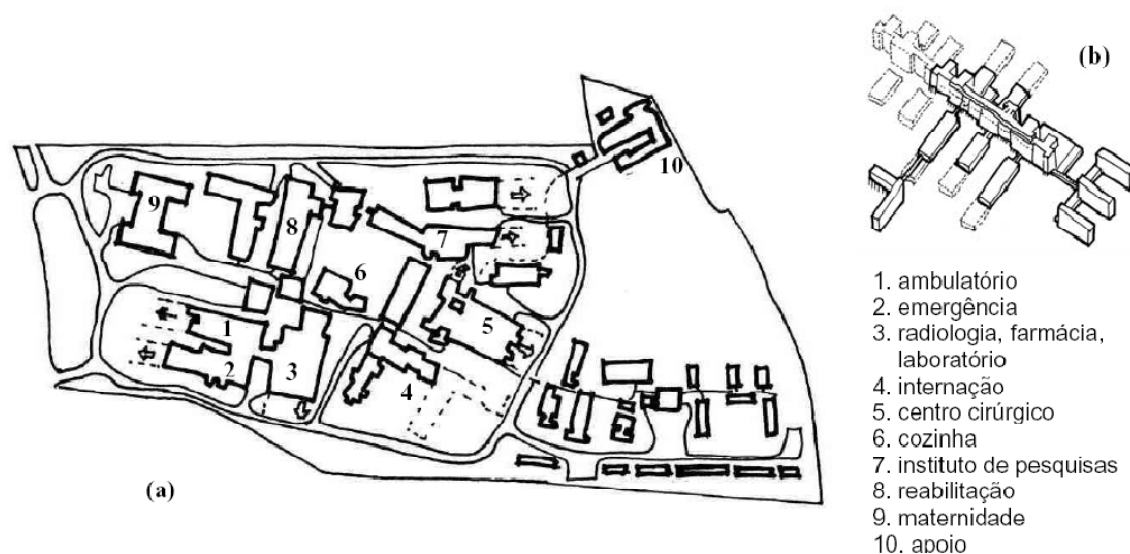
Northwick Park Hospital, Inglaterra, 1960. (a) planta; (b) esquema de expansão.
